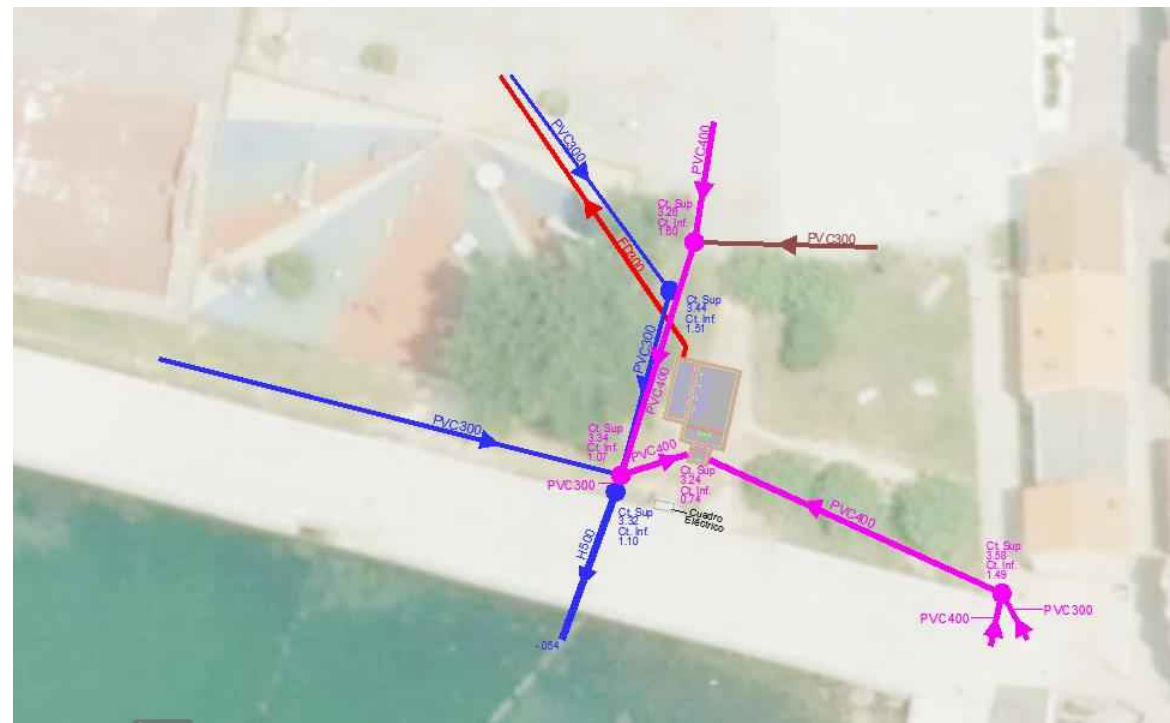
EBAR Praza do Regueiro. Planta general conexiones hidráulicas
